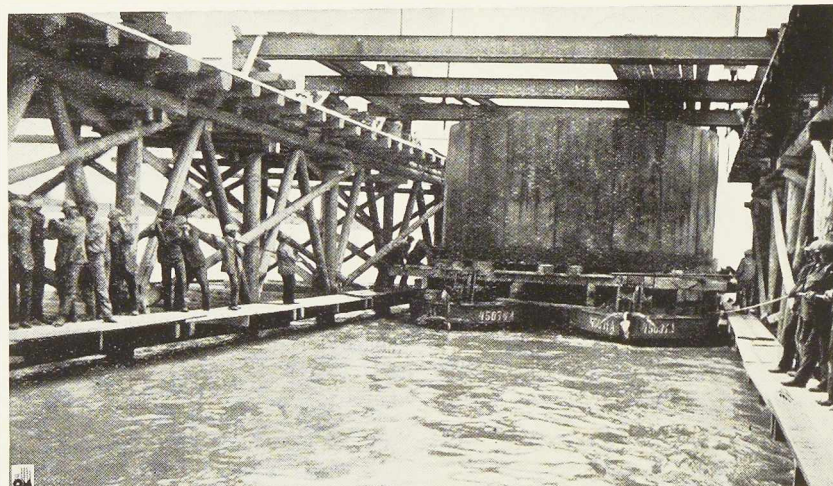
Caisson de la pile du pont-route Nicolas Horthy, halé à son emplacement définitif entre les pieux de l'échafaudage.
